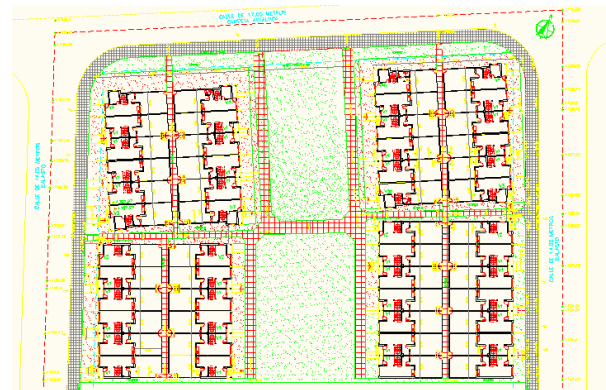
COVIFAMI: vista del conjunto y Planta General
